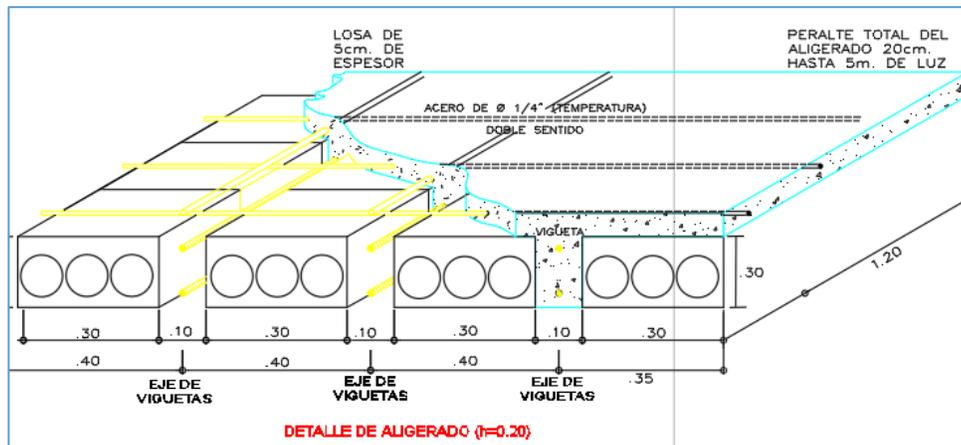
Detalle típico en 3D de la losa aligerada con 1.20m de largo
